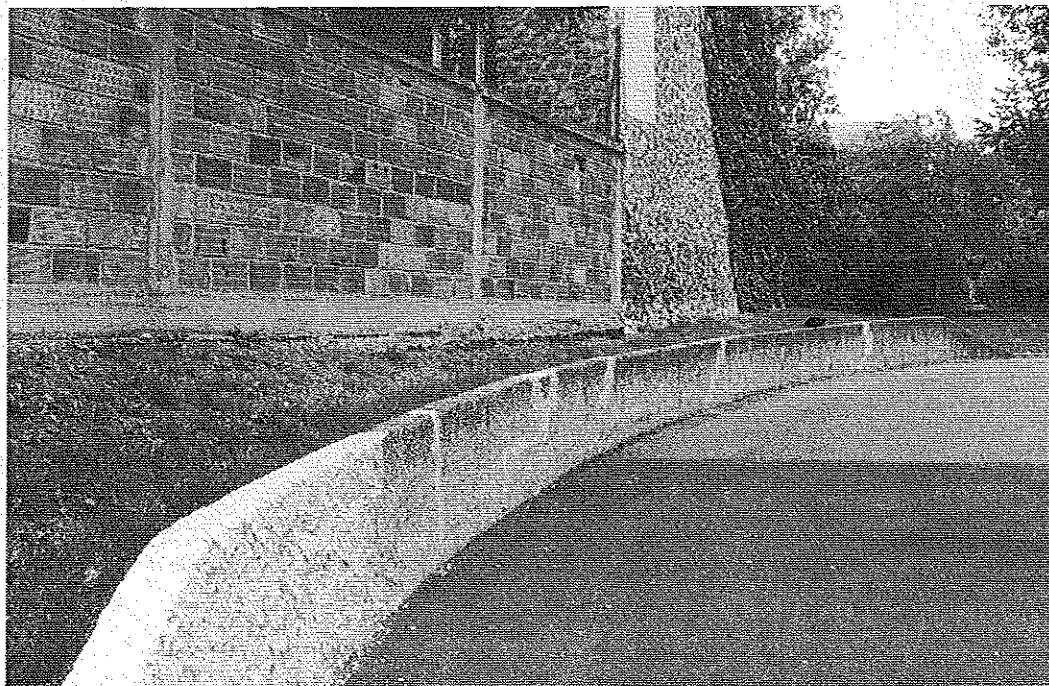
Situation après désordre. Une rampe d'accès à un parking en sous-sol est construite en limite de propriété en contrebas de la fondation du mur de clôture. © J. Putatti
